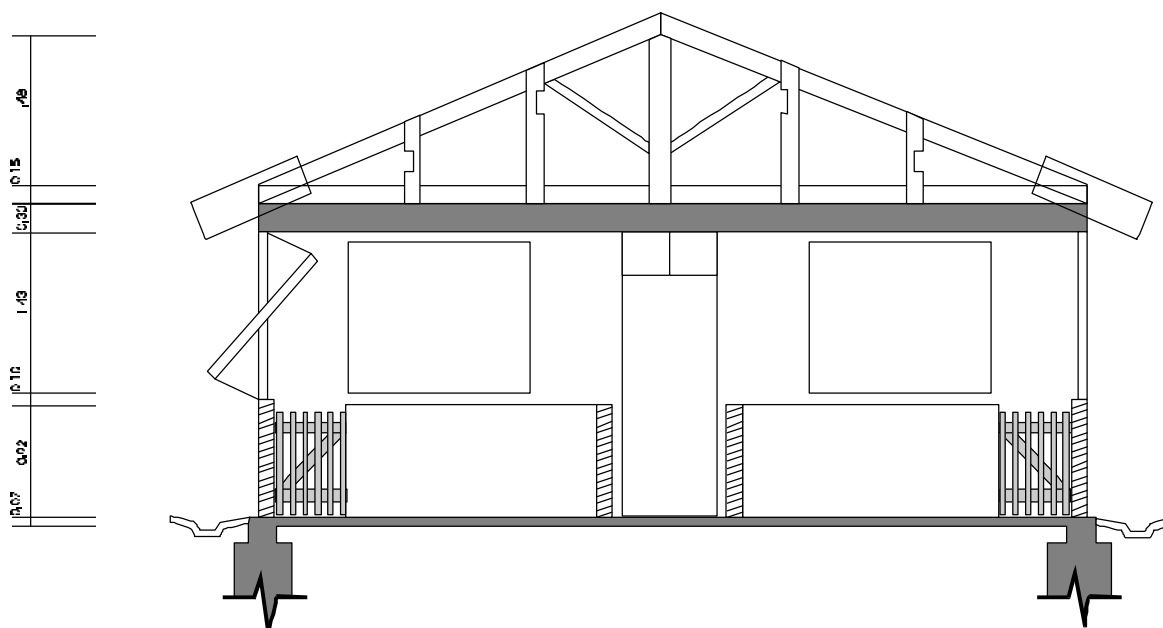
Corte transversal do galpão crescimento e terminação. S/escala. Dimensões em metros.
